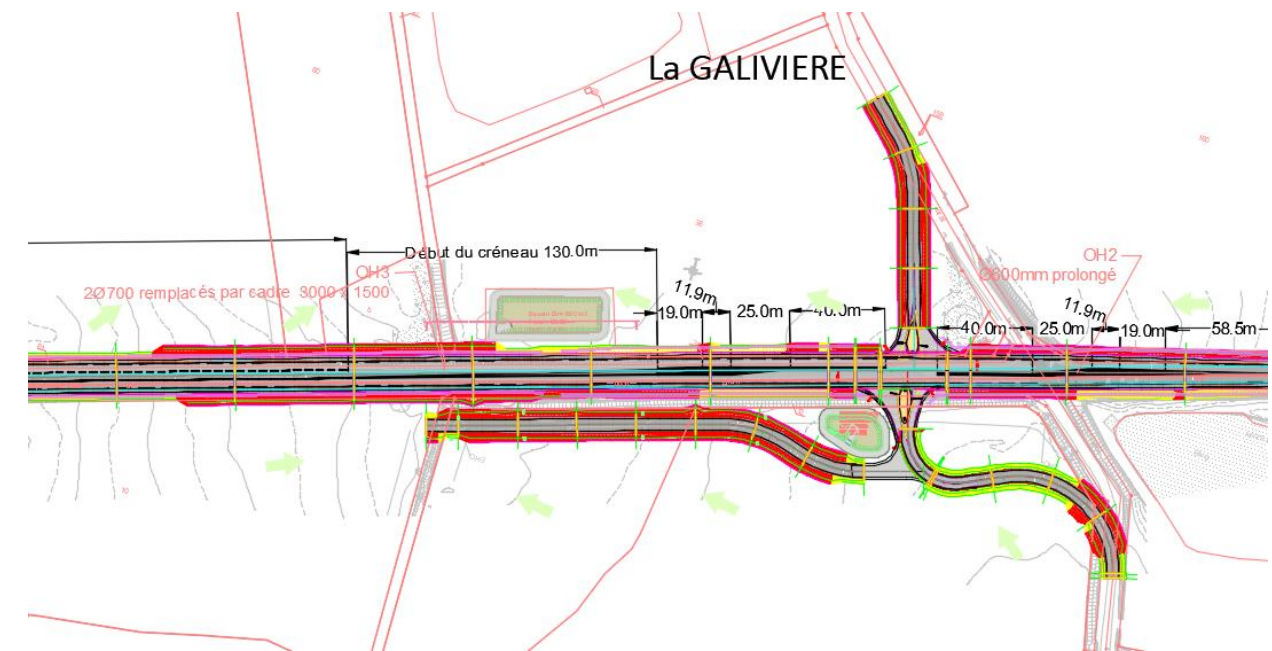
Plan du carrefour d'extrémité Est Section 1
